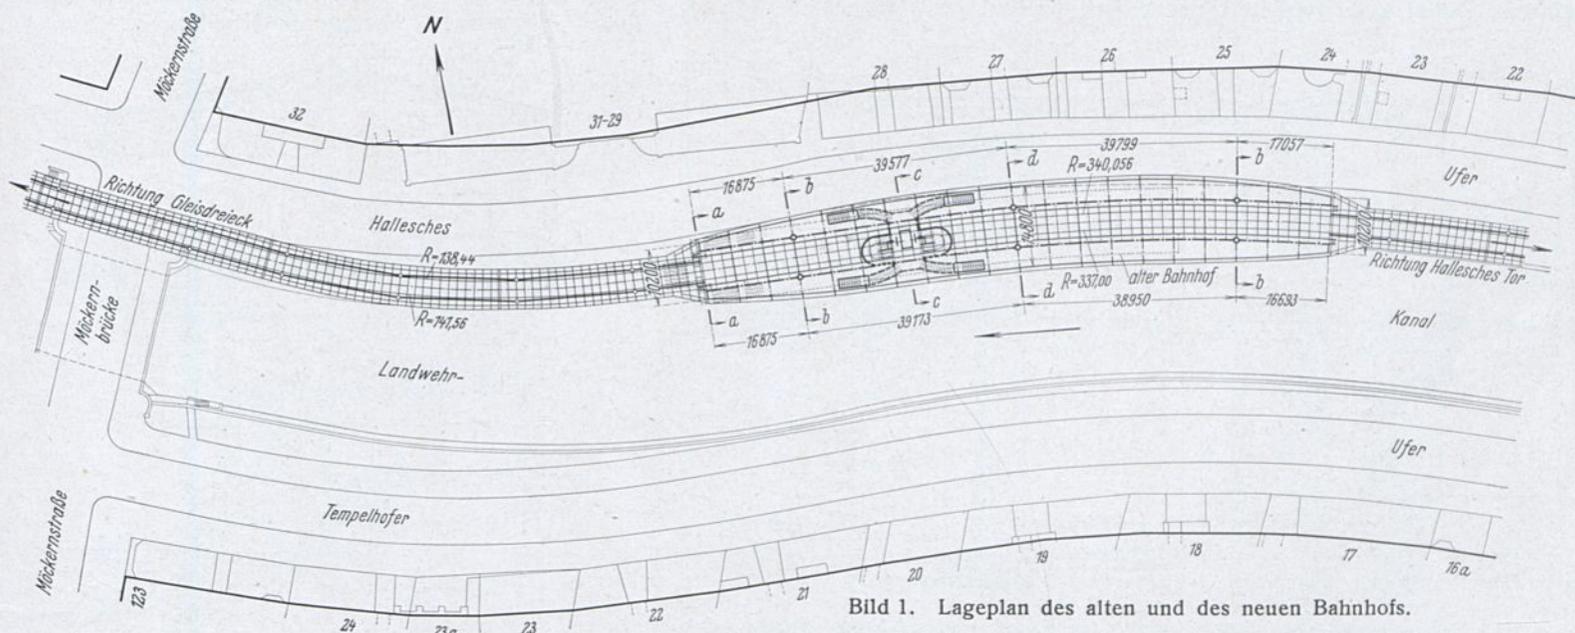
Lageplan des alten und des neuen Bahnhofs.
